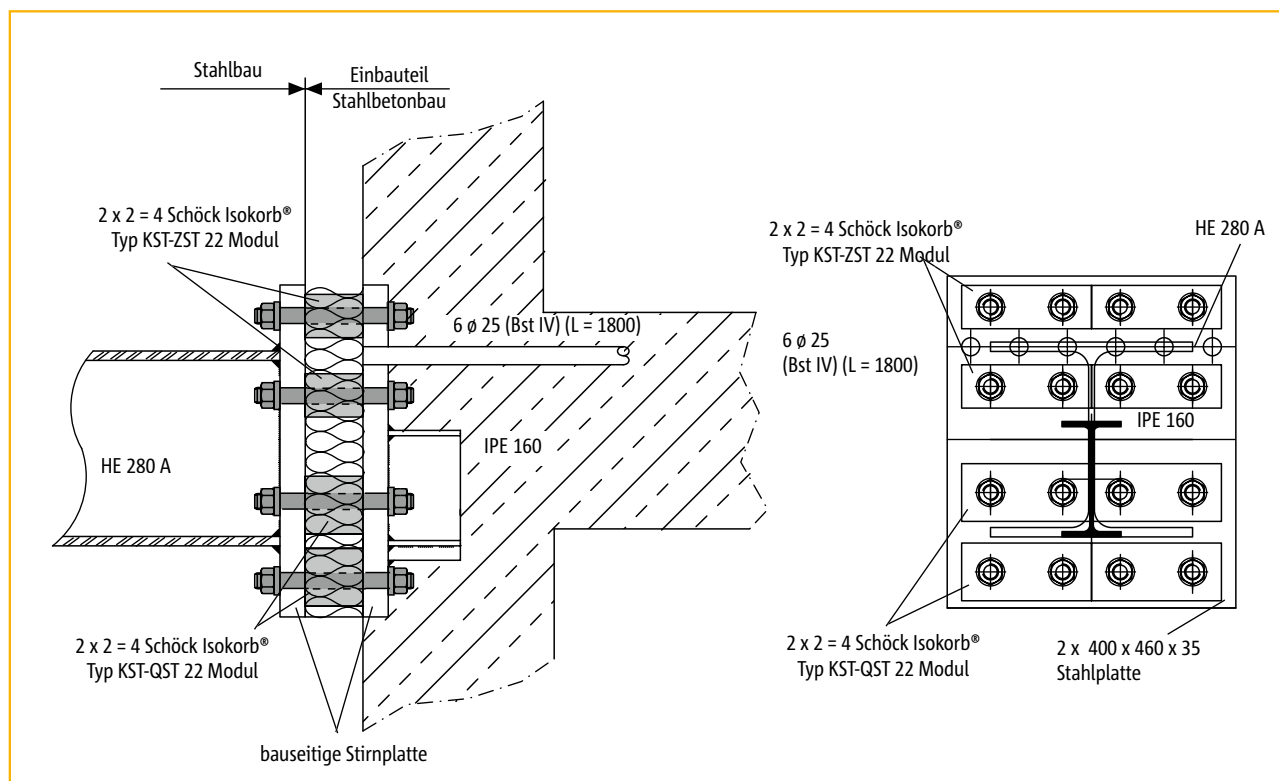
Schöck Isokorb® Typ KST beim Anwendungsfall Sanierung oder nachträgliche Balkonmontage
